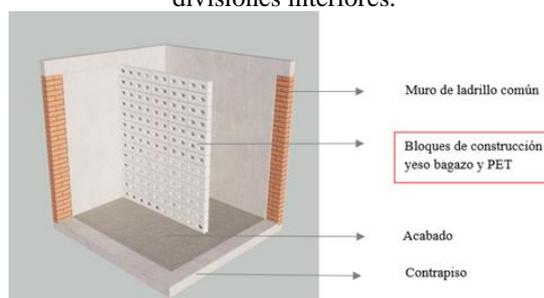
Paneles prefabricados: crear paneles ligeros y eficientes térmicamente para facilitar el transporte e instalación.
